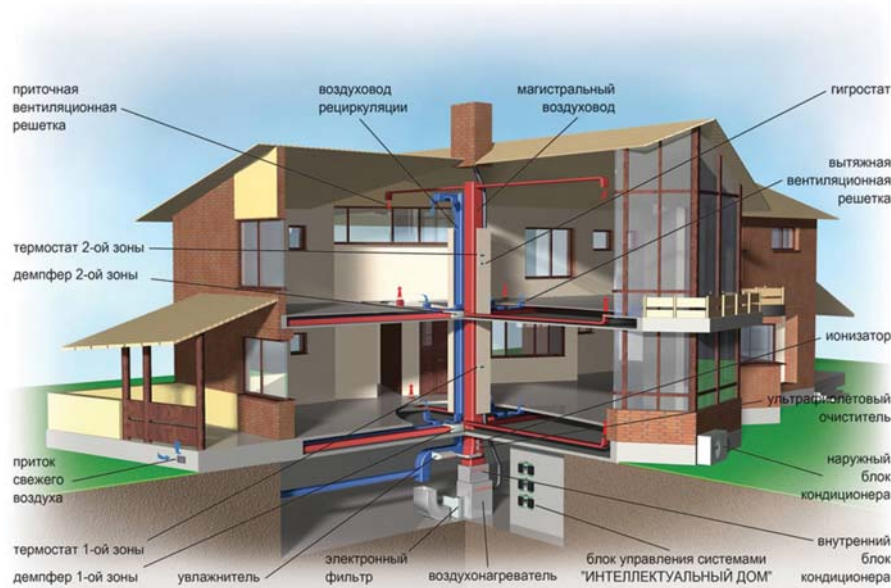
Схема систем воздушного отопления, кондиционирования и вентиляции коттеджа
